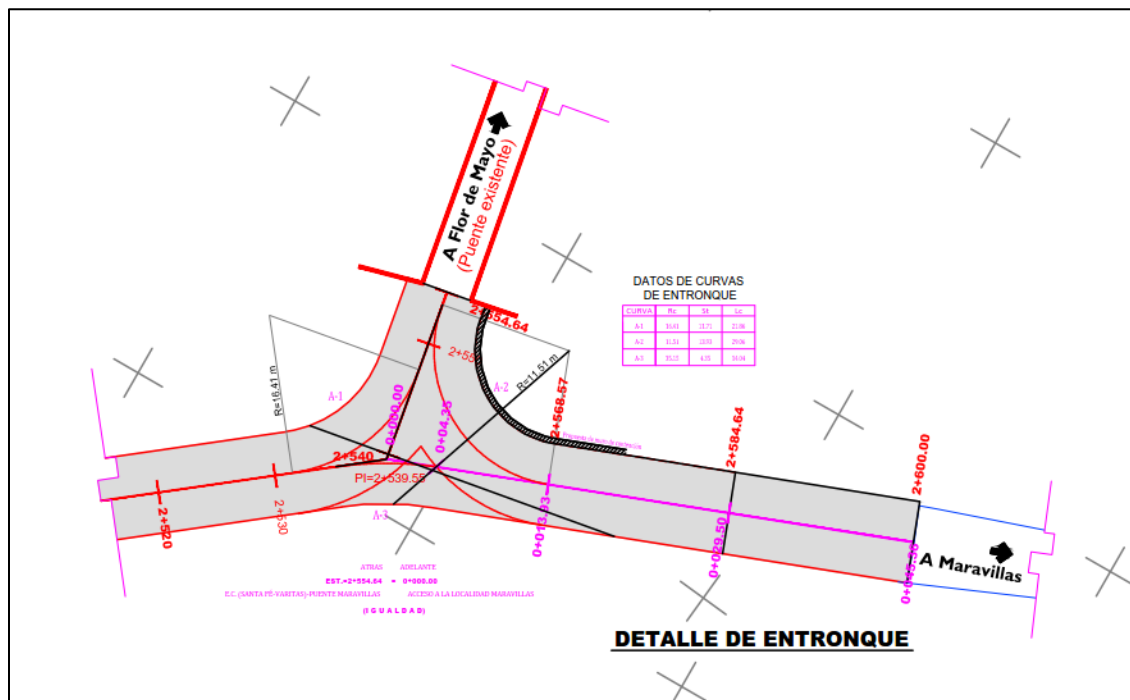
Planta general del proyecto y el entronque localizado en el Km 2+540.
